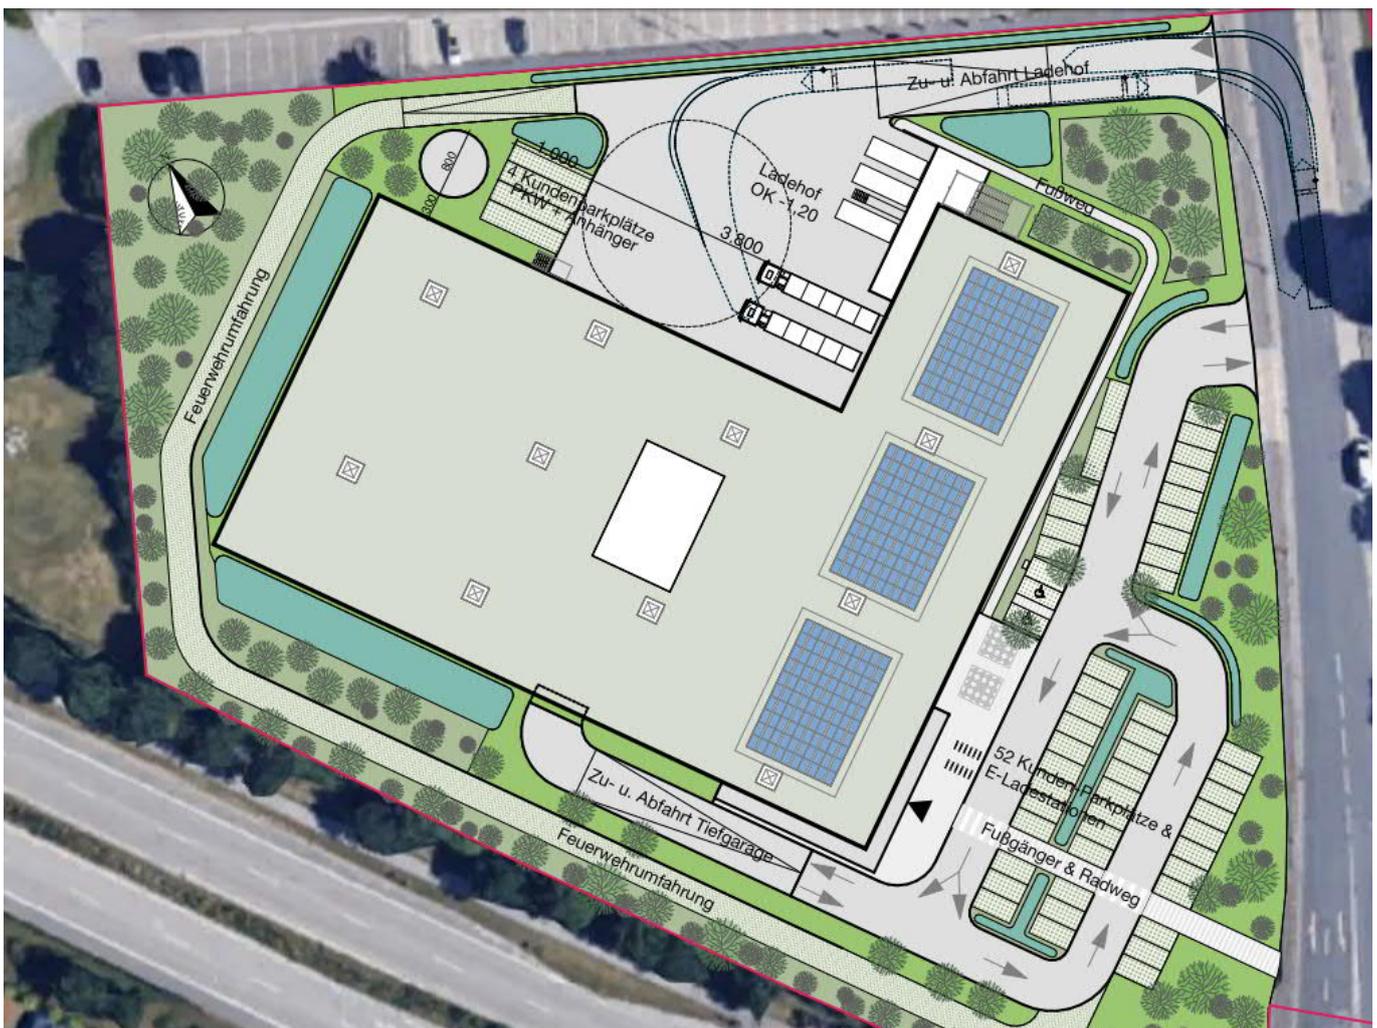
Lageplan, each Architekten, Stand 17.07.2024
